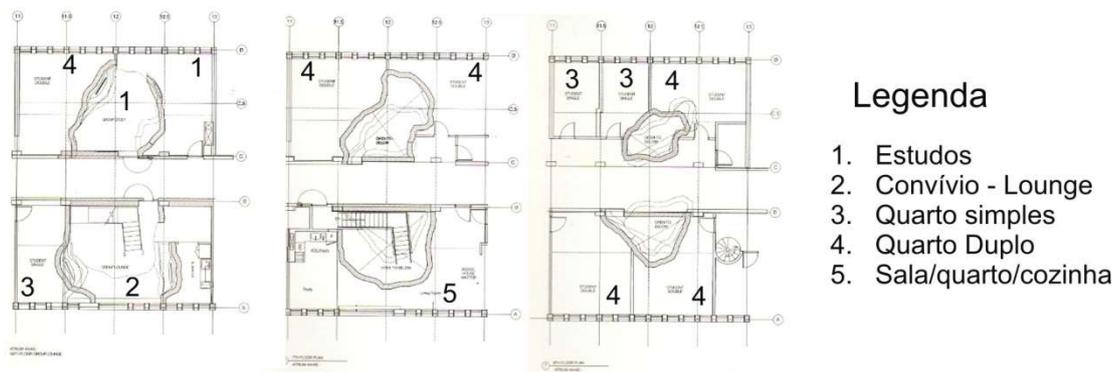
Planta - módulo habitacional - 6o, 7o e 8o pavimentos
